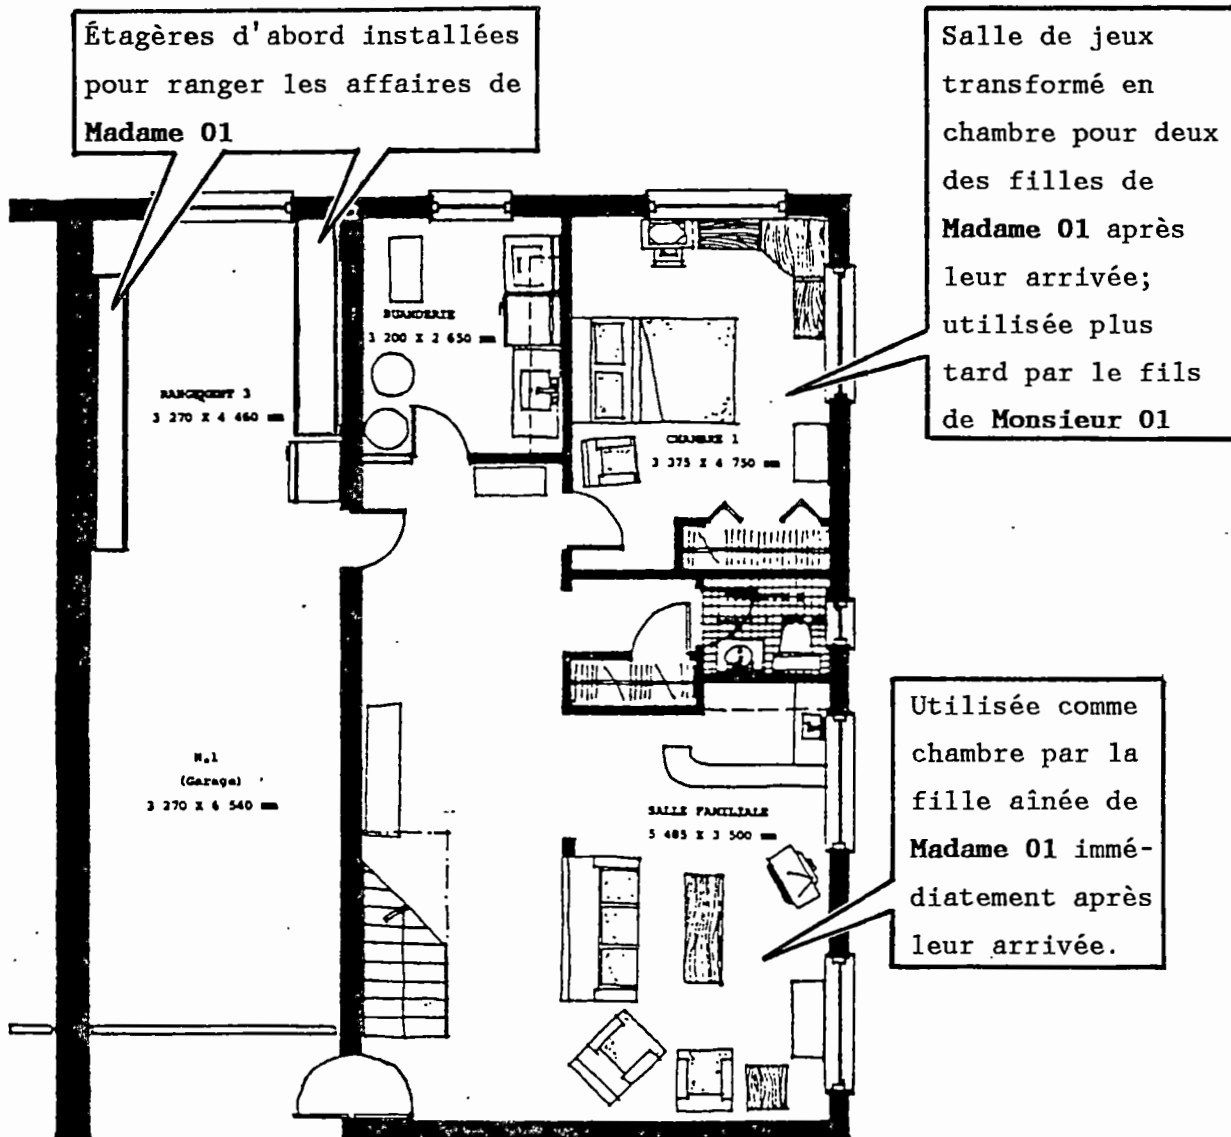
Plan du rez-de-chaussée du duplex de la Famille 01 (0170).
